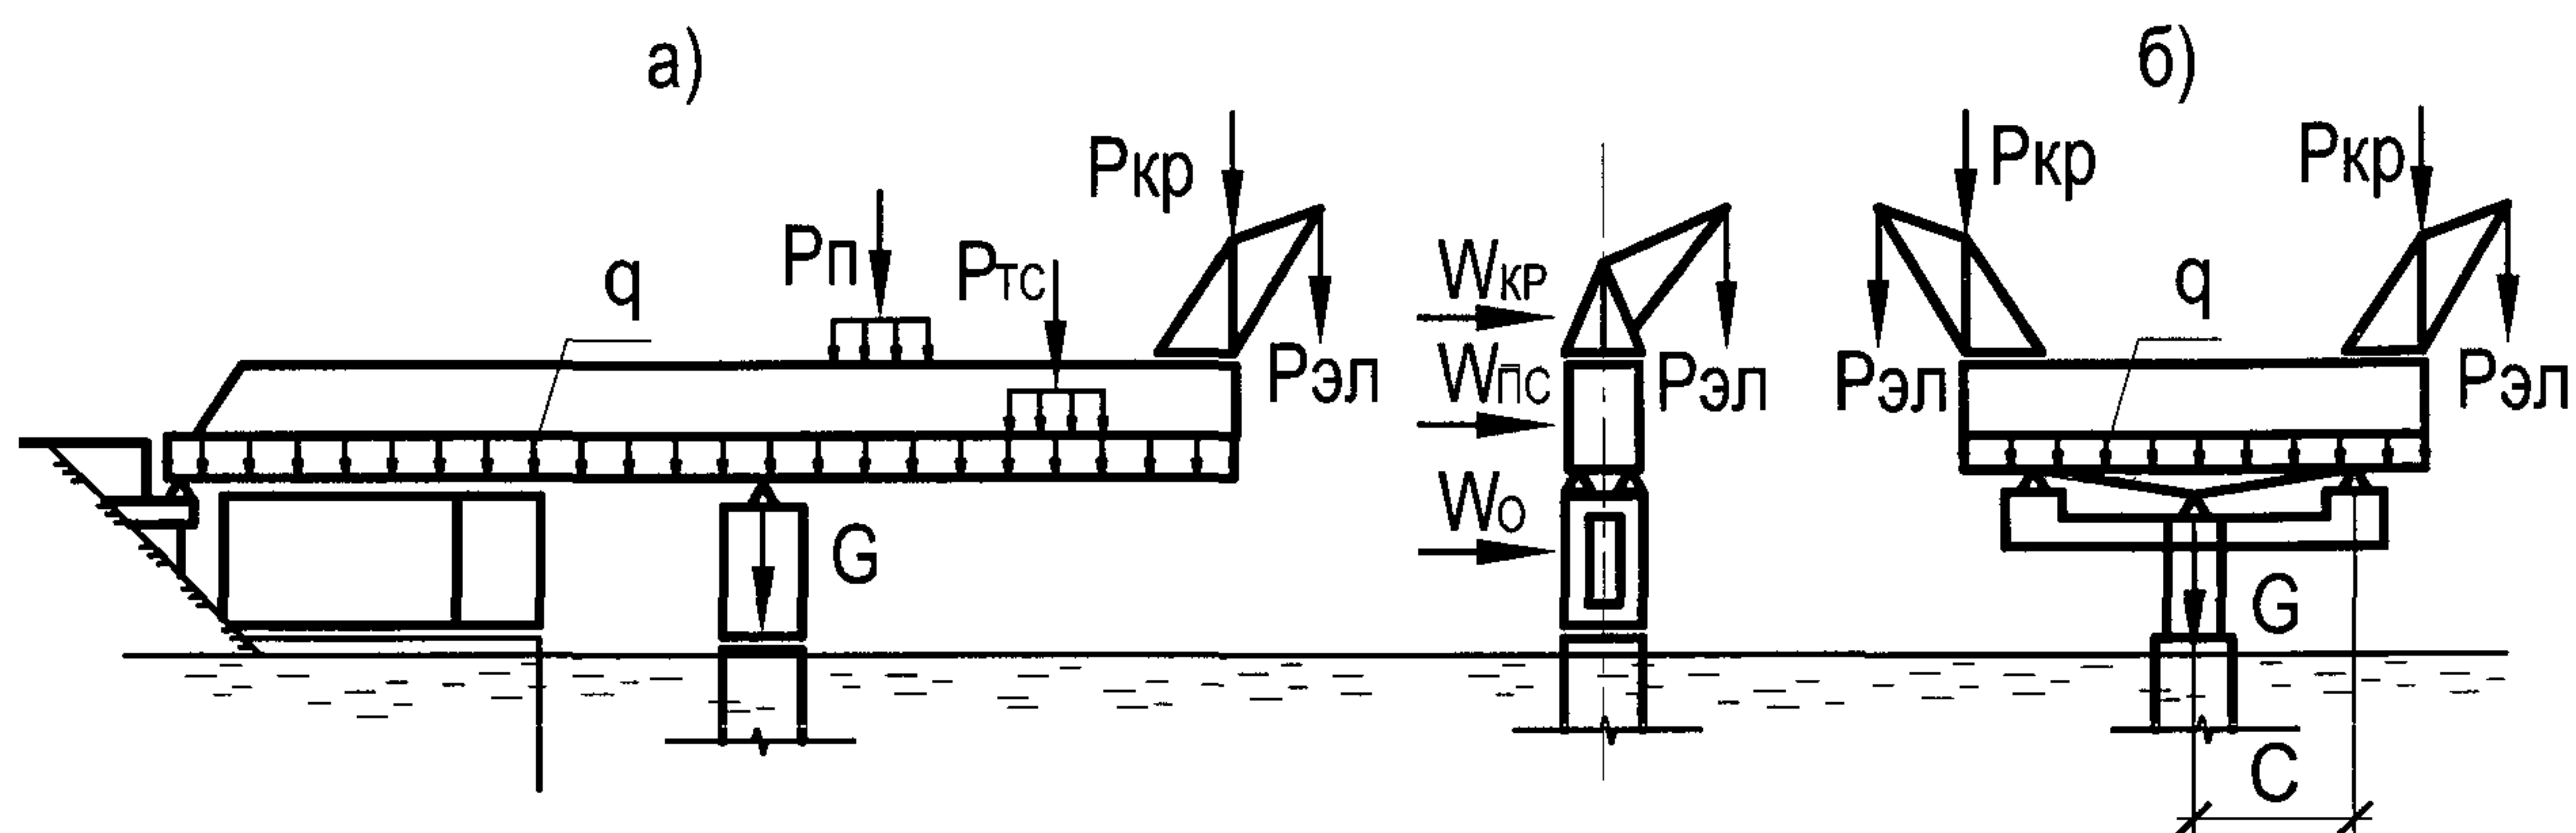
Расчетные схемы нагрузок на промежуточные опоры и опорные устройства
